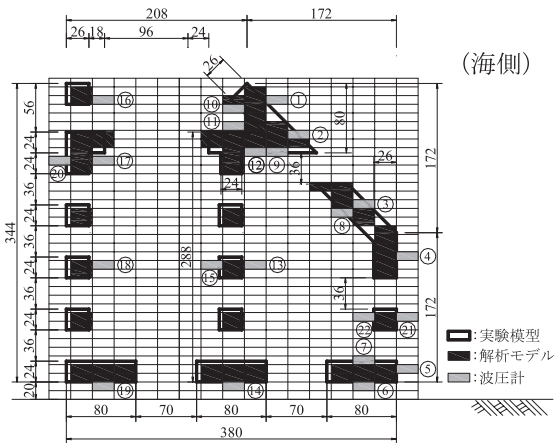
波力低減型海域制御構造物の解析構造断面図 (単位: mm)
